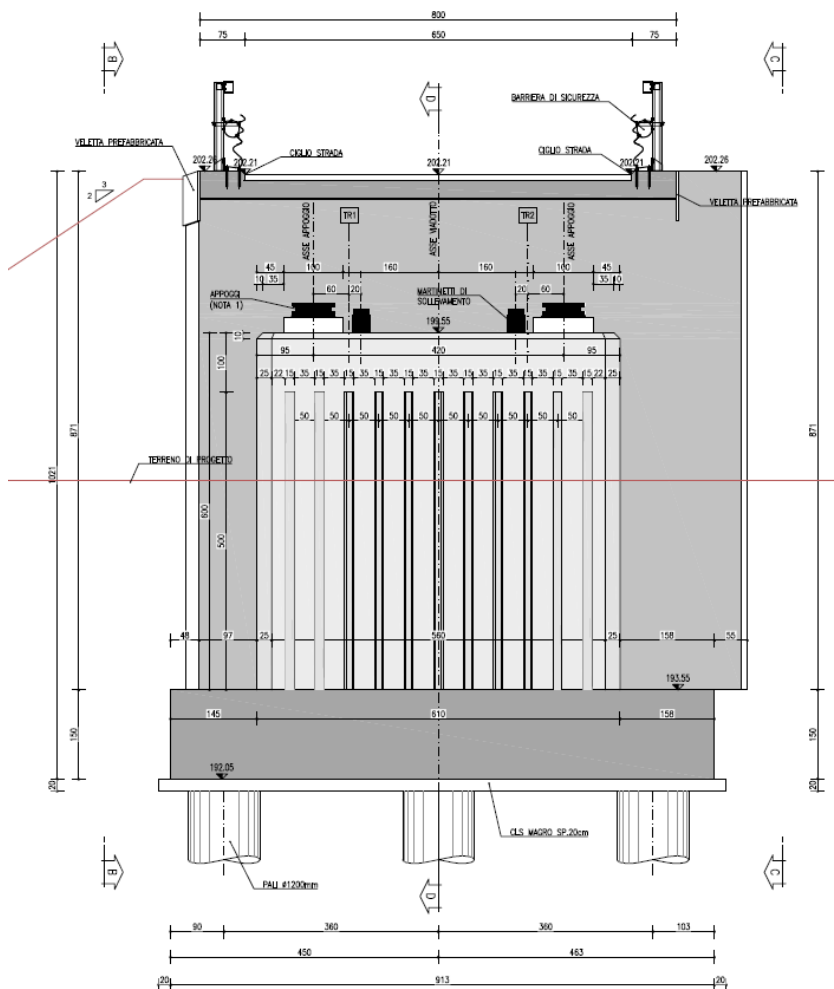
Spalla 1 - carpenteria elevazioni
